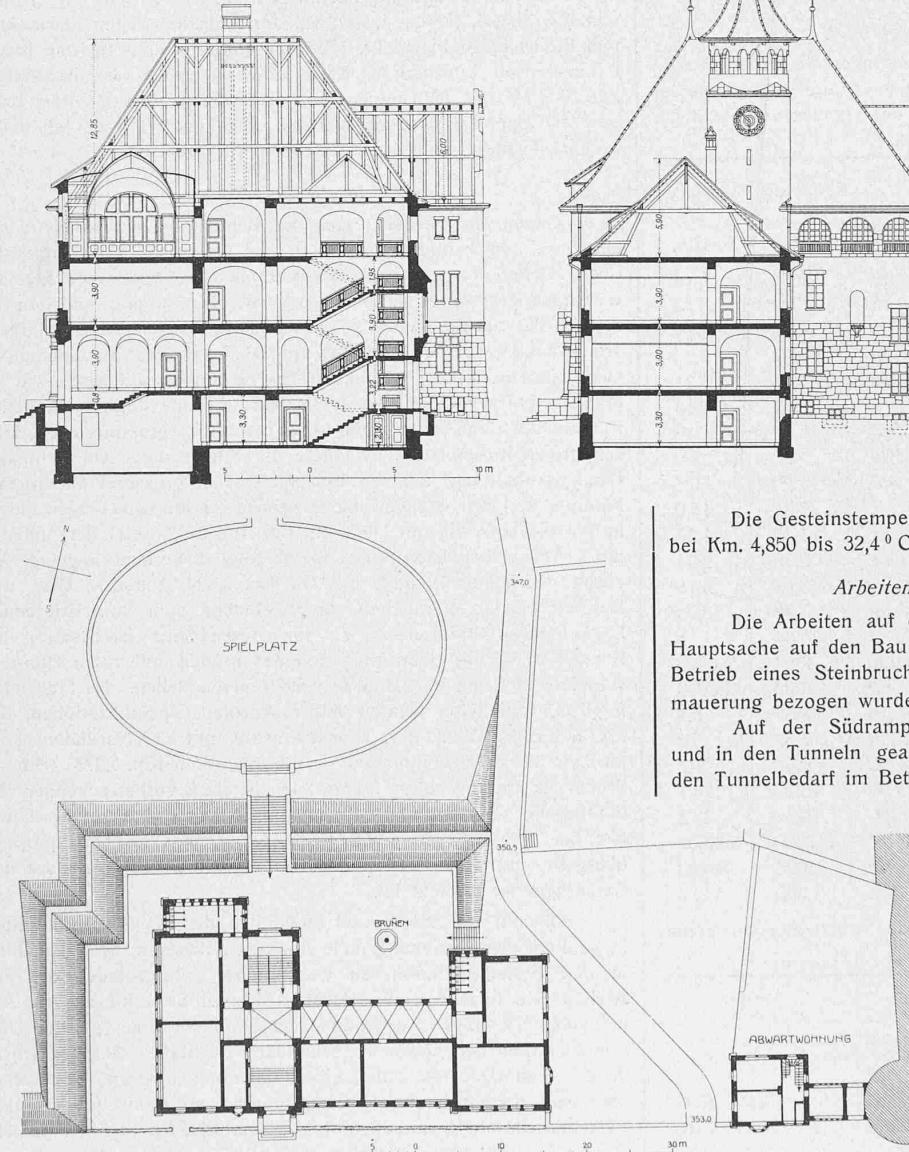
bis 3. Lageplan und Erdgeschossgesamtgrundriss 1:800, Schnitte 1:400 der Gemeindeschule.
